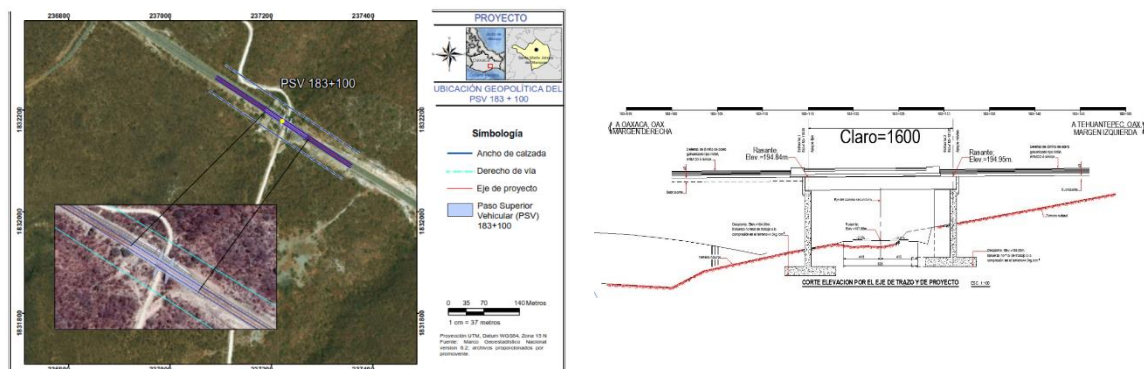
Proyecto en planta y corte longitudinal del PSV 183+100.
